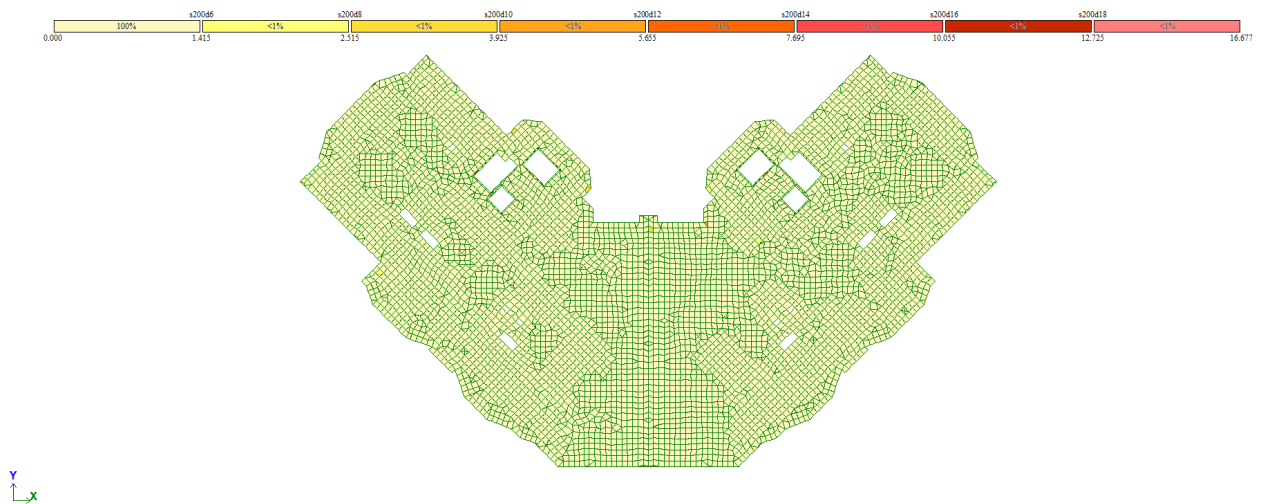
Площа арматури плити на 1 м. п. по осі y (нижня грань)
